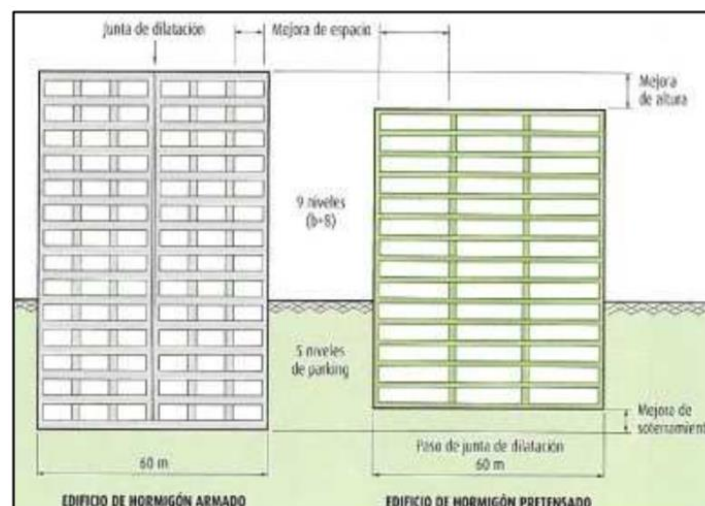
Comparativa entre edificios de hormigón armado y hormigón pretensado
